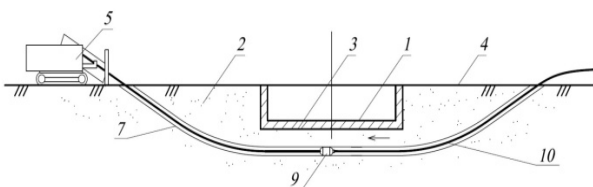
Вертикальний переріз осі напрямної свердловини з уведенням гнучких тяг: 1-споруда; 2-ґрунт; 3-підосва споруди; 4-денна поверхня; 5-бурова установка; 7-напрямна свердловина; 9-розширювач свердловин; 10-гнучкі тяги
